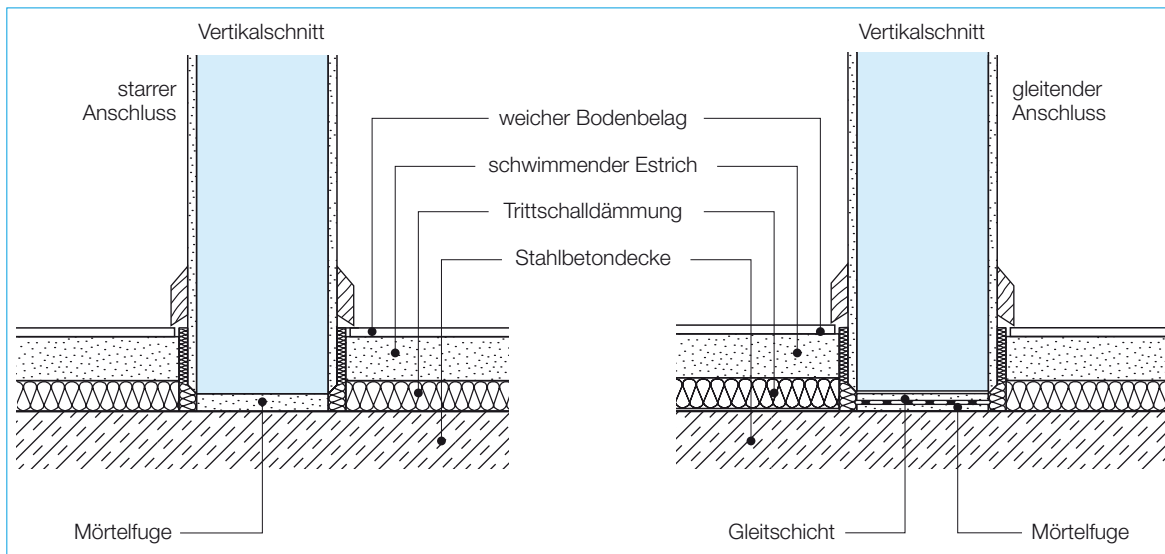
Unterer Anschluss nicht tragender Innenwände aus Porenbetonmauerwerk
